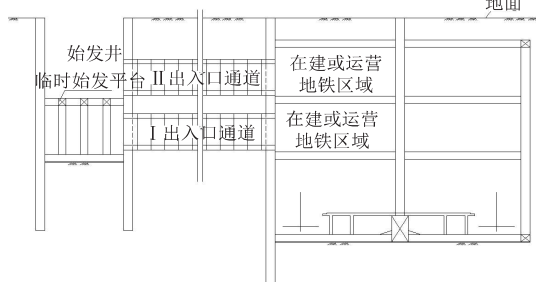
彭城广场站Ⅰ、Ⅱ号出入口矩形顶管立面图
